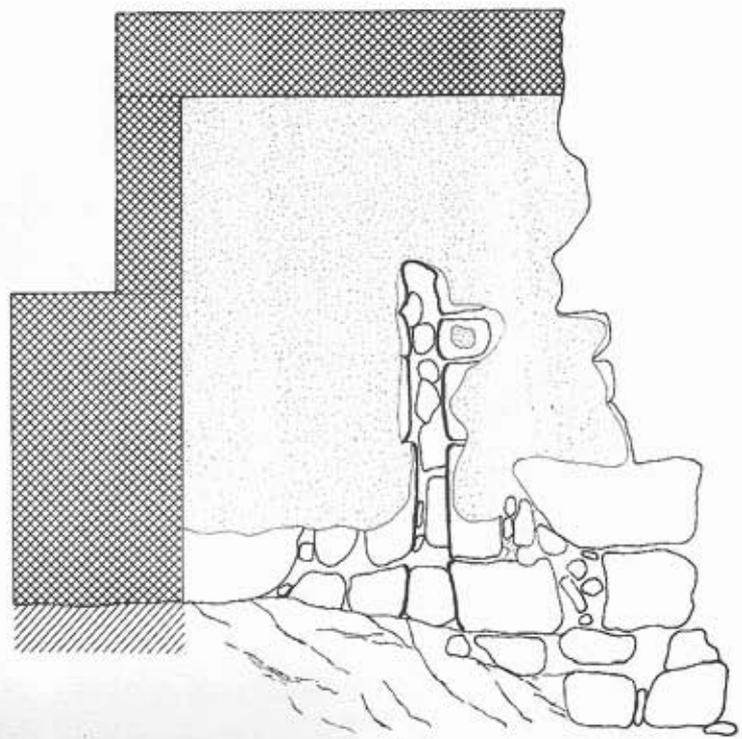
Baño caliente, alzado de los muros. 1) muro norte; 2) m
